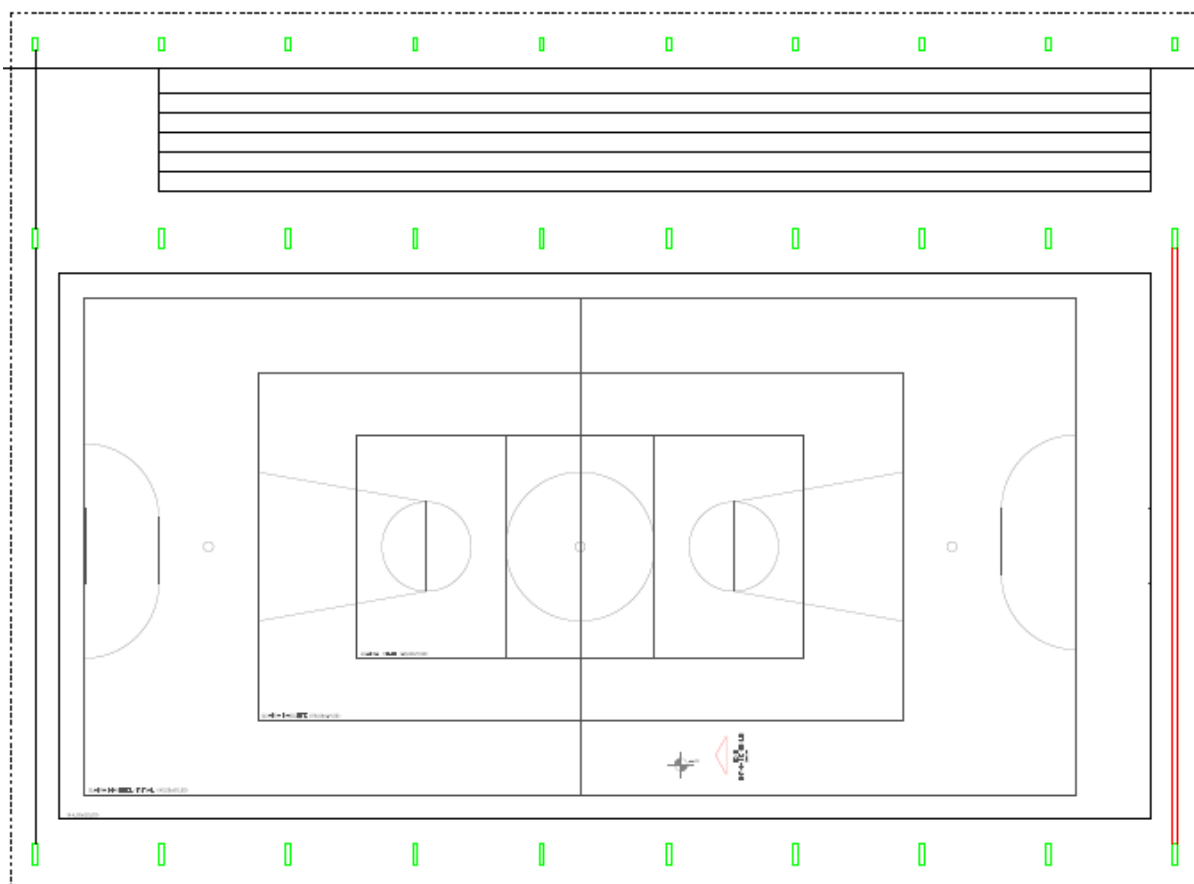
Planta Baixa da Quadra Poliesportiva em Análise.
